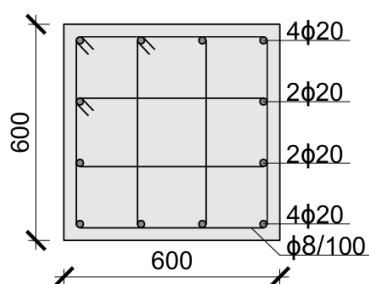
Sezione trasversale tipo dei pilastri con dettaglio dell'armatura longitudinale e trasversale – sezione 1 (quote espresse in mm)
